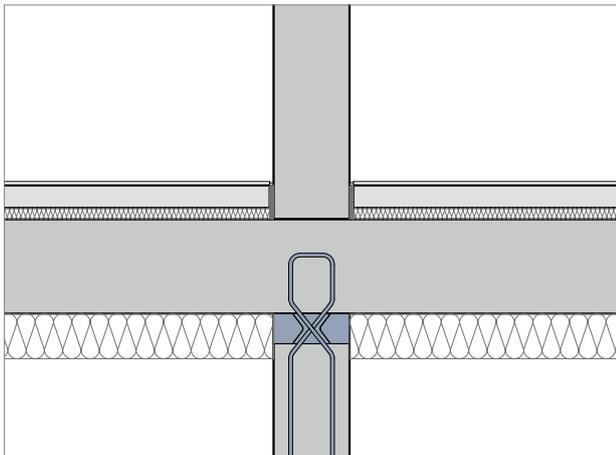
Schöck Sconnex® Typ W bei Innenwand und Unterdeckendämmung
